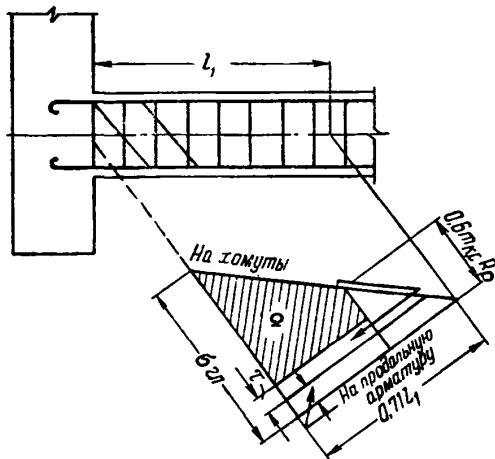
Схема распределения усилий при расчете поперечной арматуры по эпюре главных растягивающих напряжений
